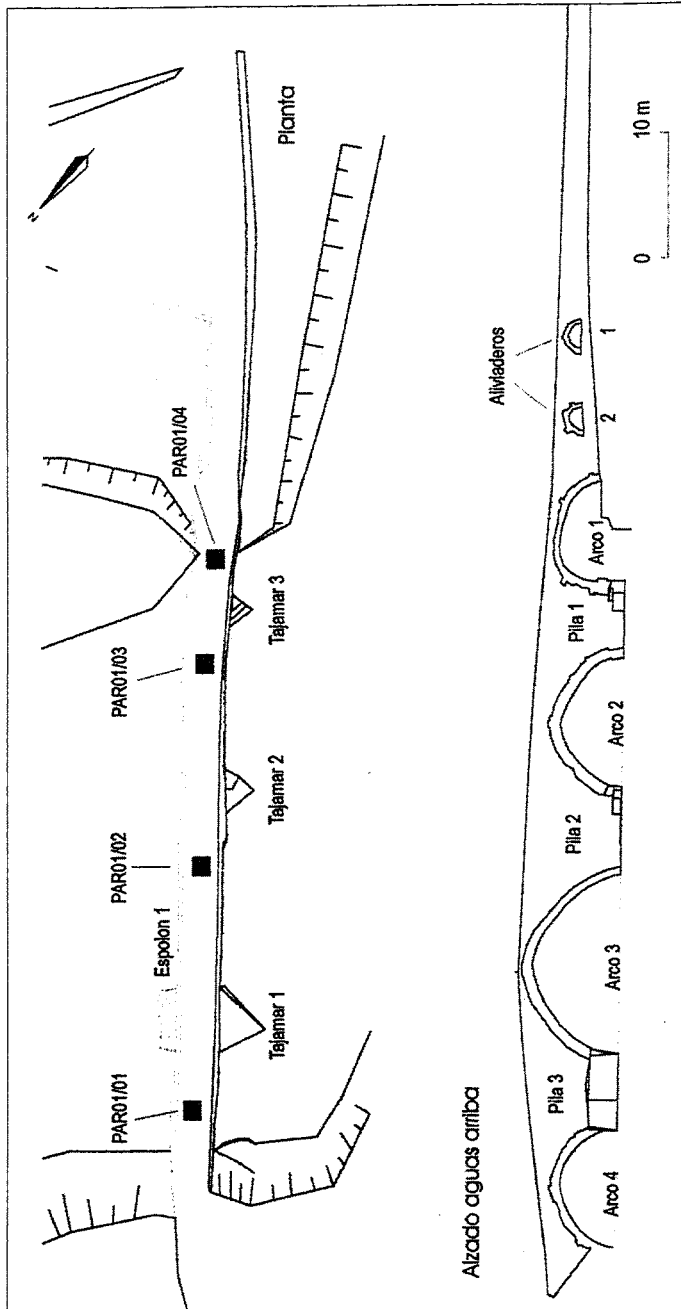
Planta del puente con emplazamiento de sondeos arqueológicos, y alzado con enumeración de elementos estructurales.
